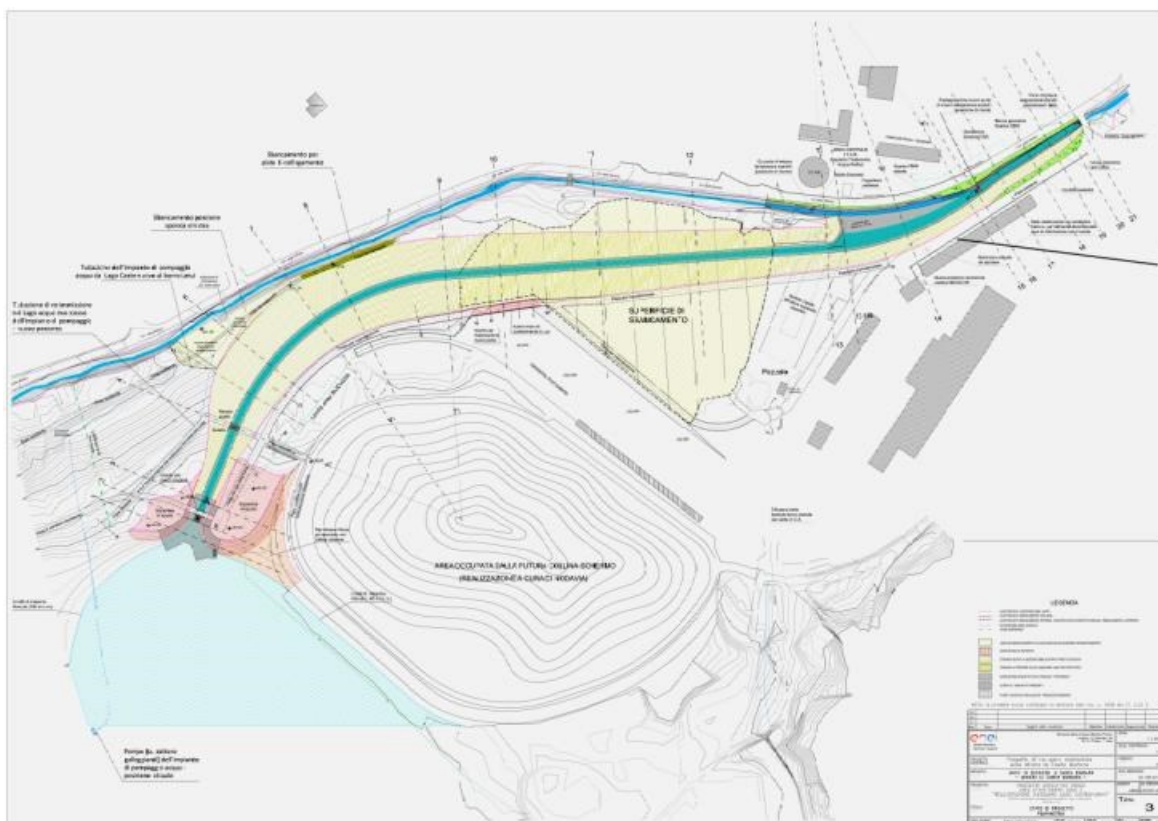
Emissario Lago Castelnuovo: planimetria generale
